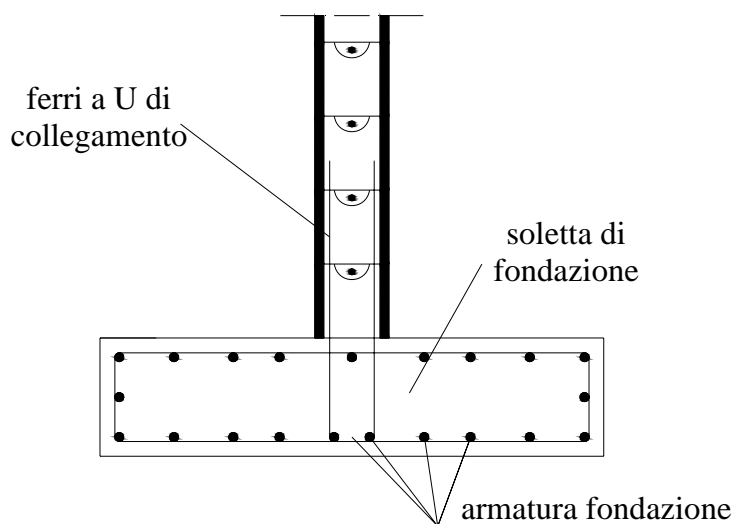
Schema di disposizione delle armature di collegamento alla fondazione
